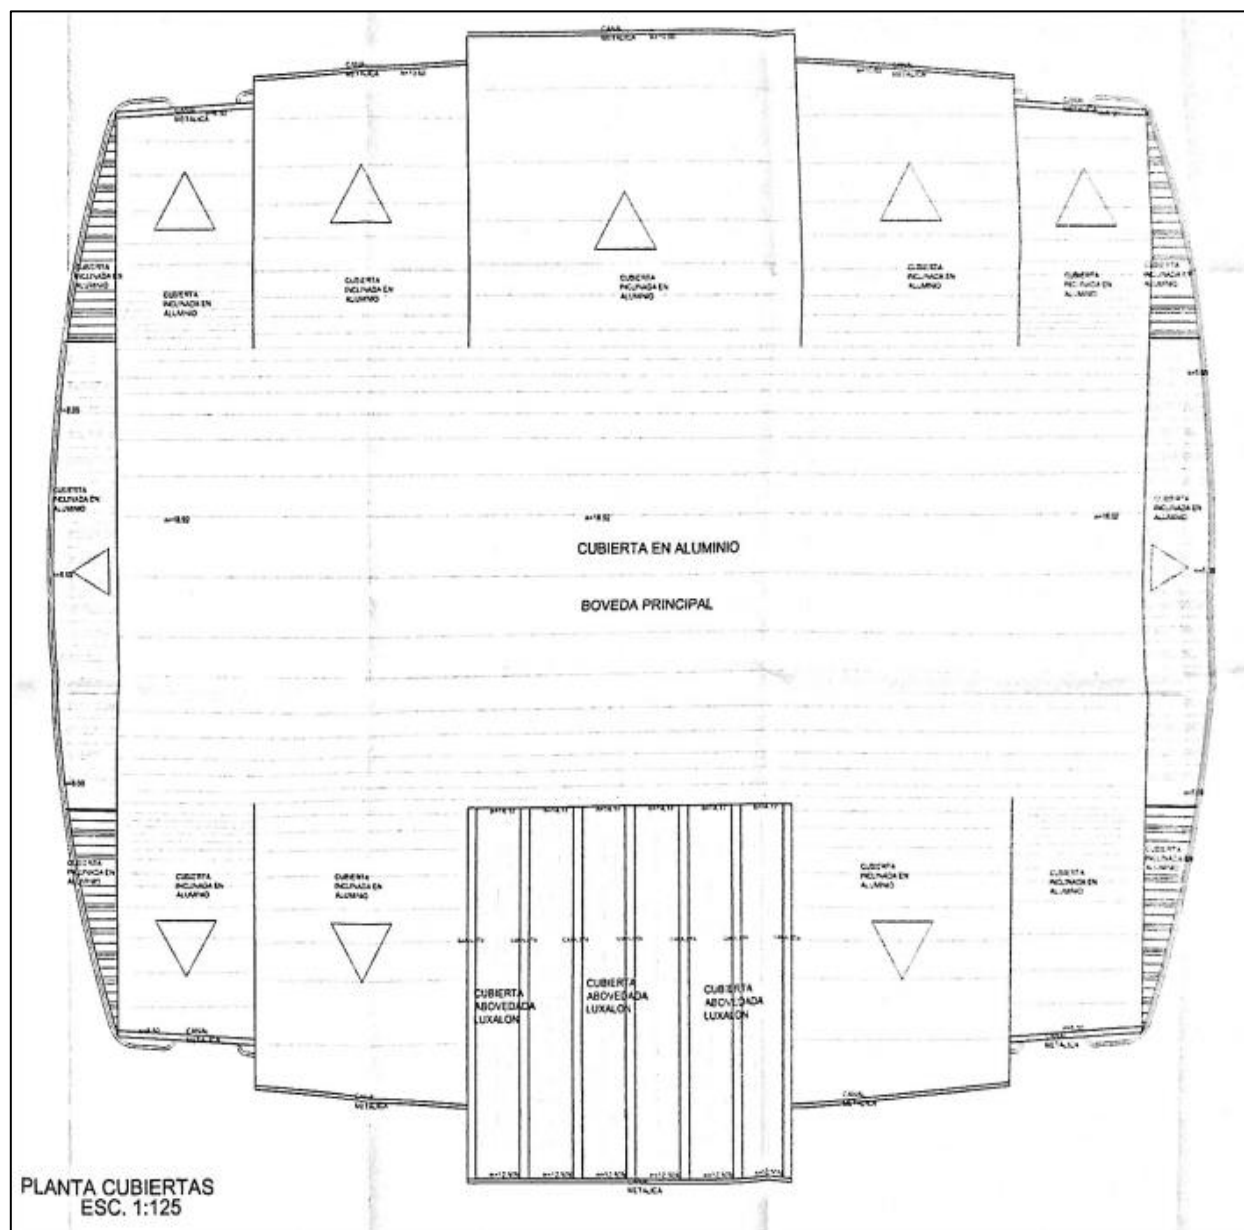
Planta General Cubierta Coliseo León XIII.
